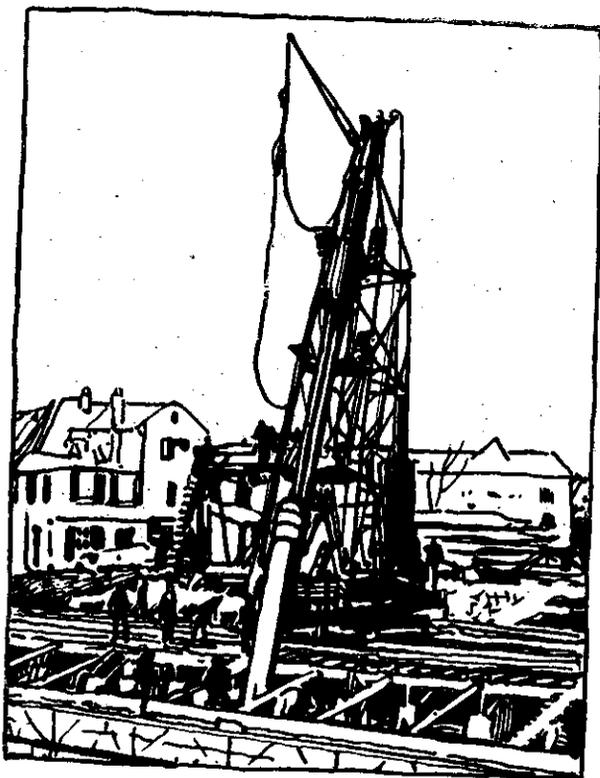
Устройство основания сооружения из железобетонных свай. На переднем плане видна свая, арматура которой обнажена от облегающего ее бетона.
